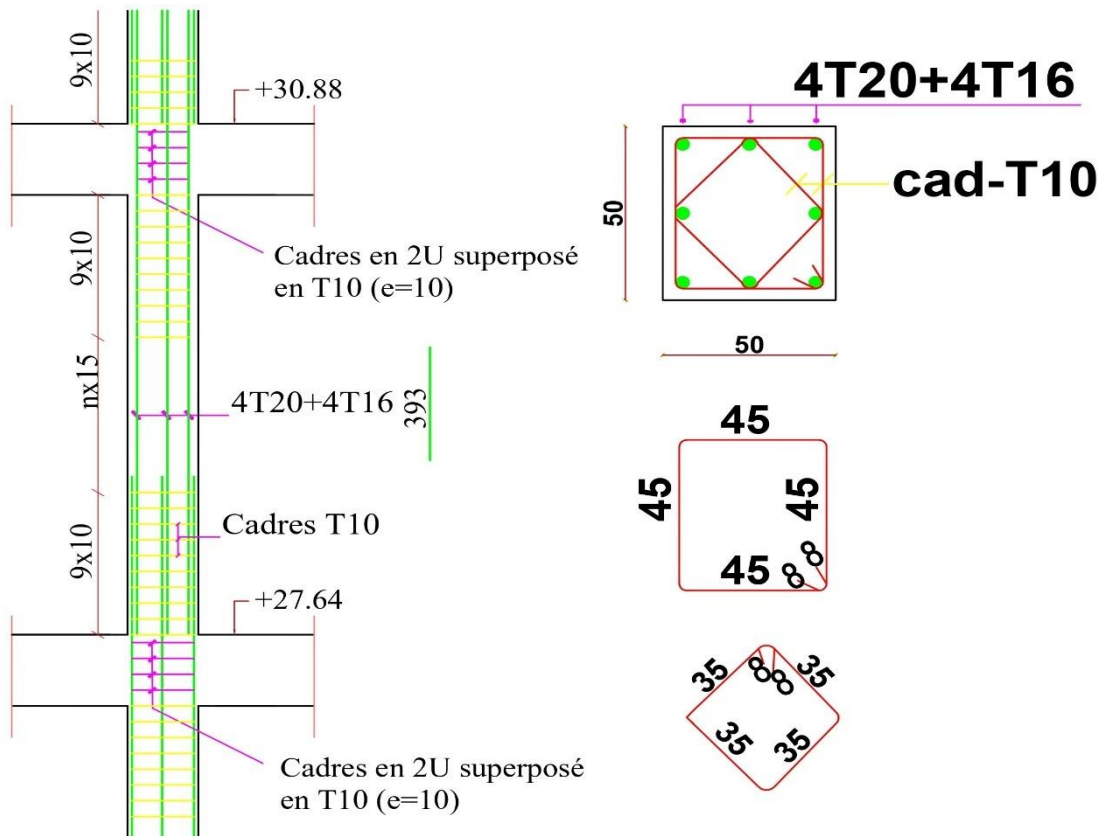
Schéma de ferrailage du poteau (50×50)
